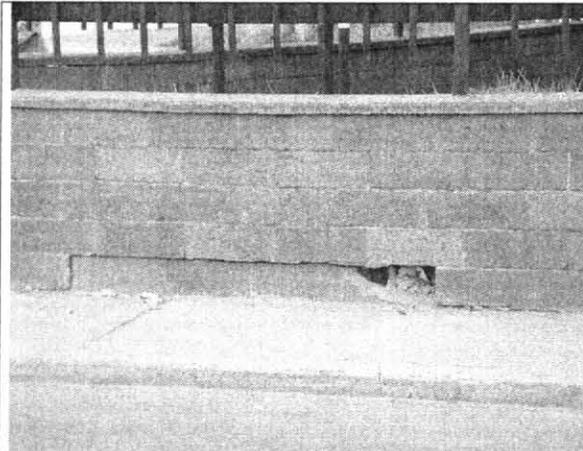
Agrietamiento horizontal con pérdida de piezas de mampostería, vista externa.
